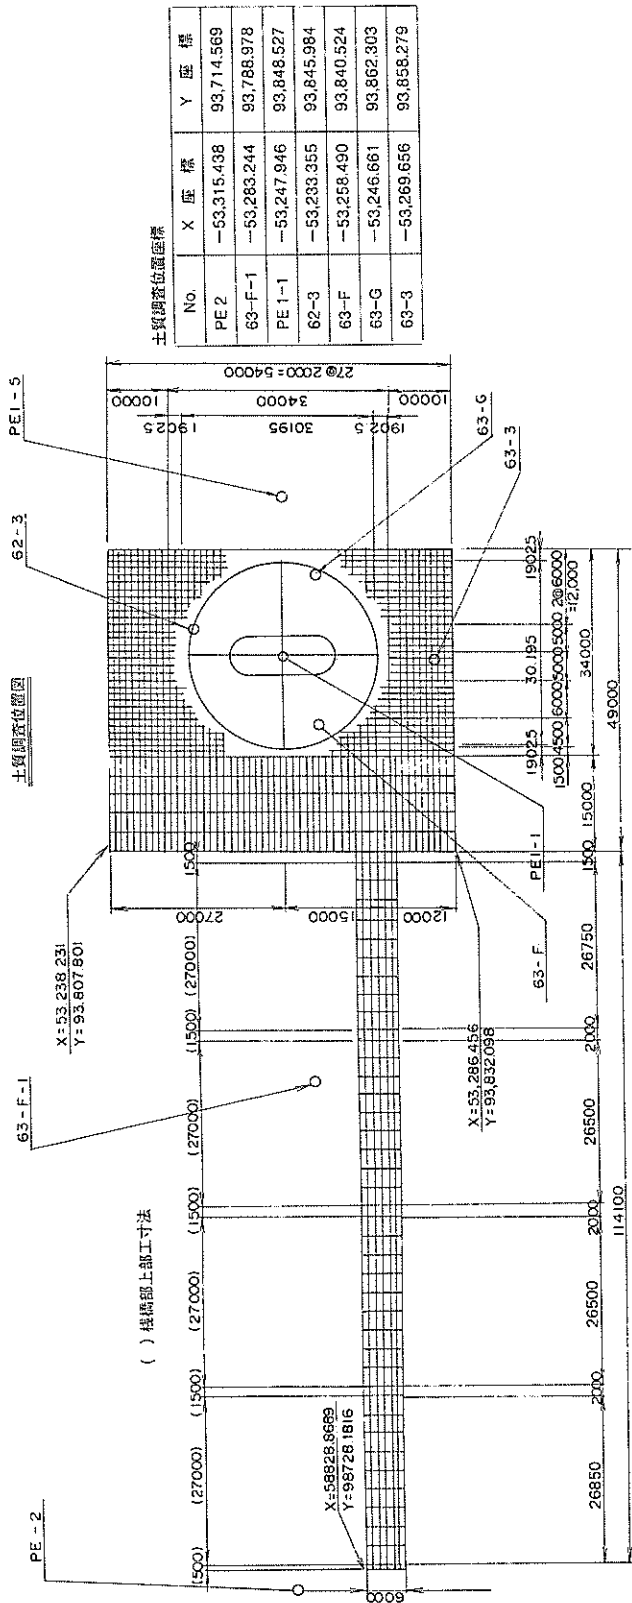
江島橋梁井筒基礎⑳ 断面図
